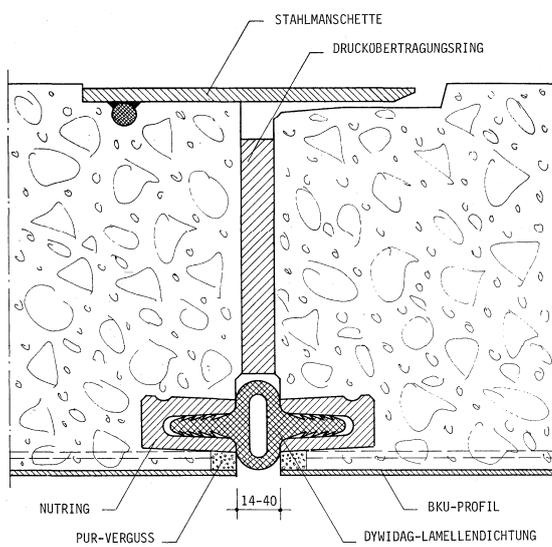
BKU-Vortriebsrohr mit Lamellendichtung [25]
